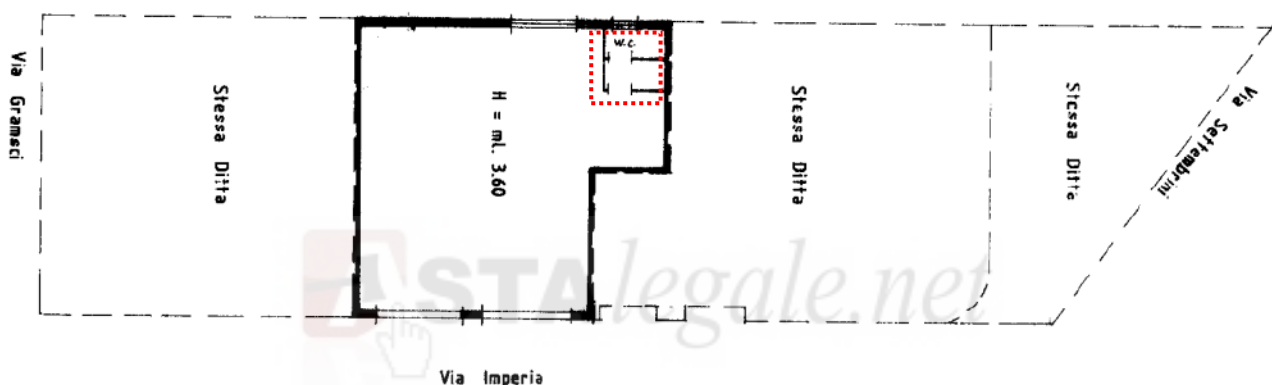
Miniatura planimetria catastale lotto 2, con indicate le difformità rilevate
